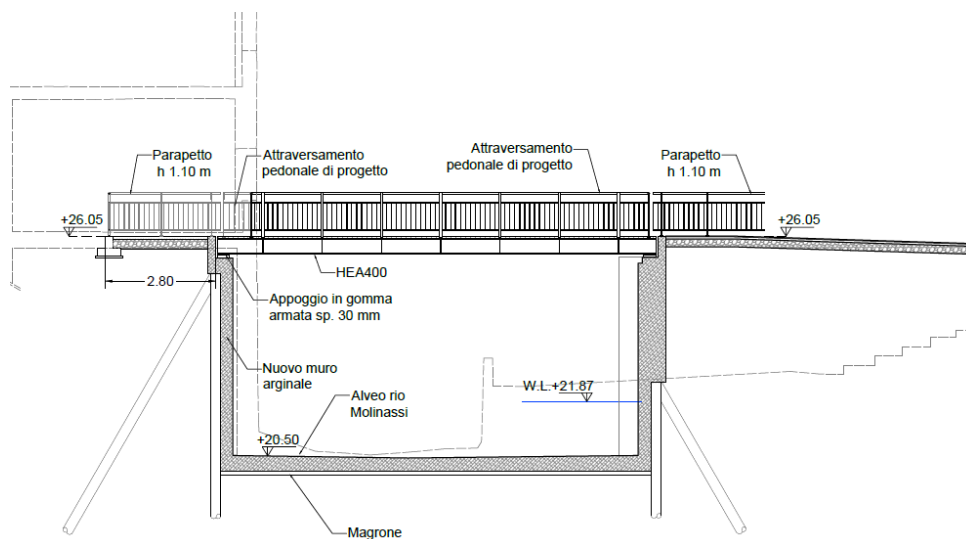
Sezione del nuovo ponte pedonabile in Via Negroponte
